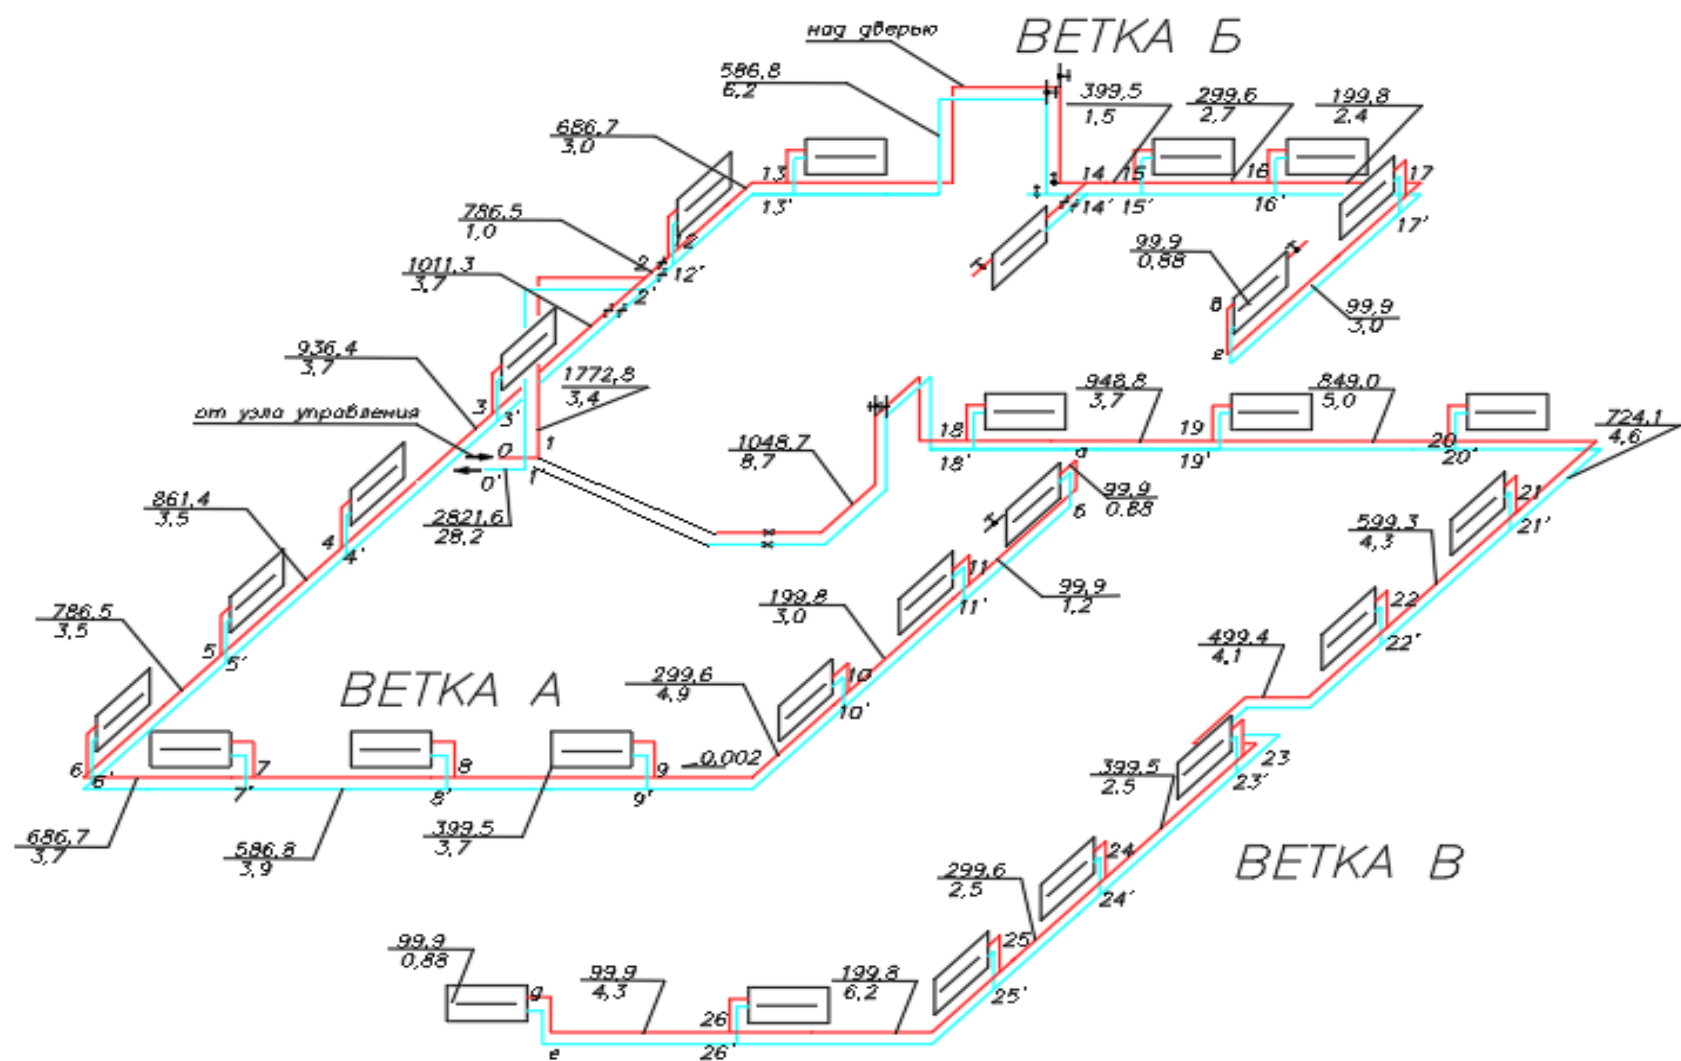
Расчетная схема системы отопления 2го этажа
